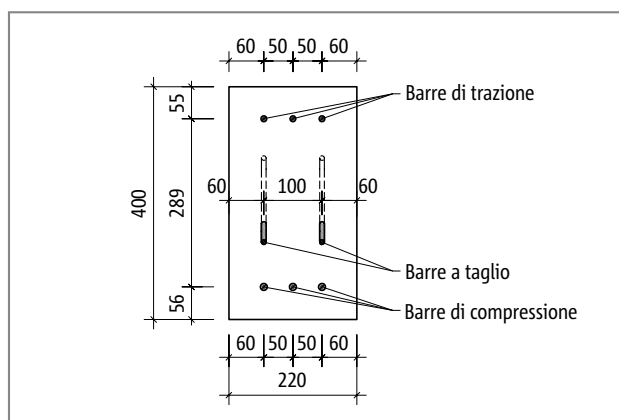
Schöck Isokorb® tipo SXT1: vista dell'elemento
